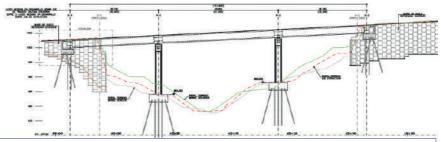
Alzado esquemático del viaducto 'pequeño' de la calzada sentido Madrid.
